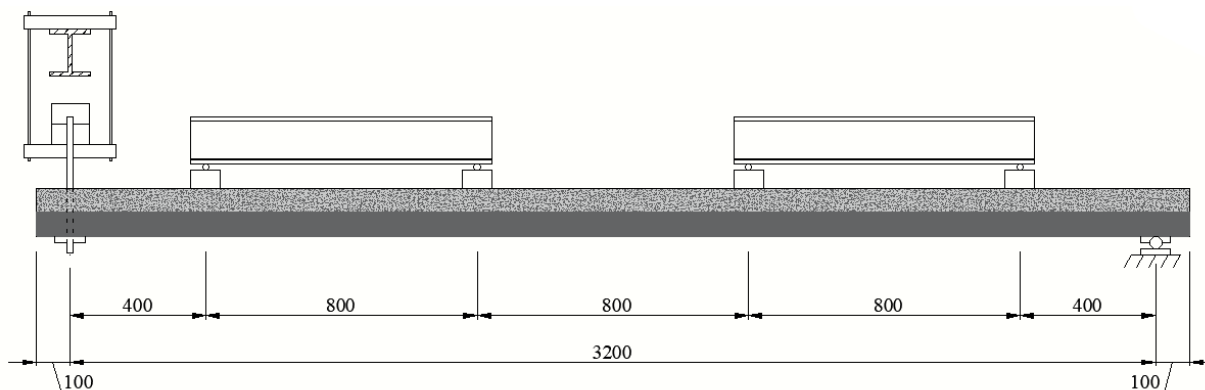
Secção longitudinal da laje Hamerlinck, 1991 - Experimental
